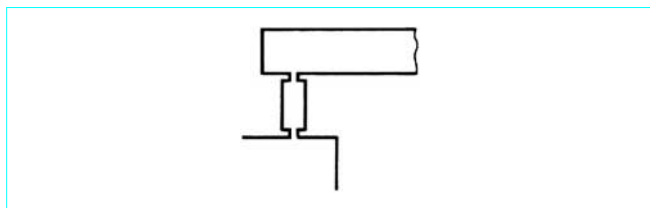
Appui d'une poutre sur pendule avec deux articulations à section rétrécie
